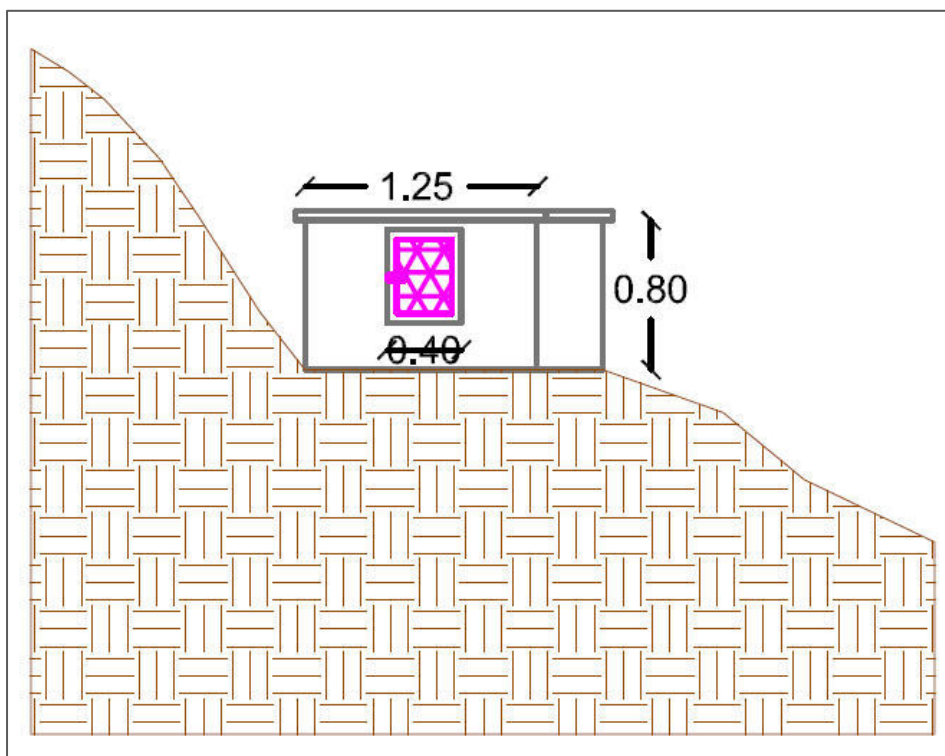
Prospetto frontale Sorgente 2 Le Pierine
